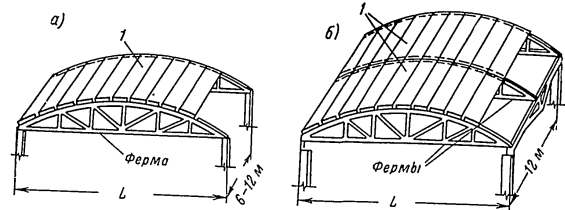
Покрытие типовой ячейки одноэтажного промышленного здания а — без подстропильной балки, б — с подстропильной балкой, 1 — крупнопанельные плиты
